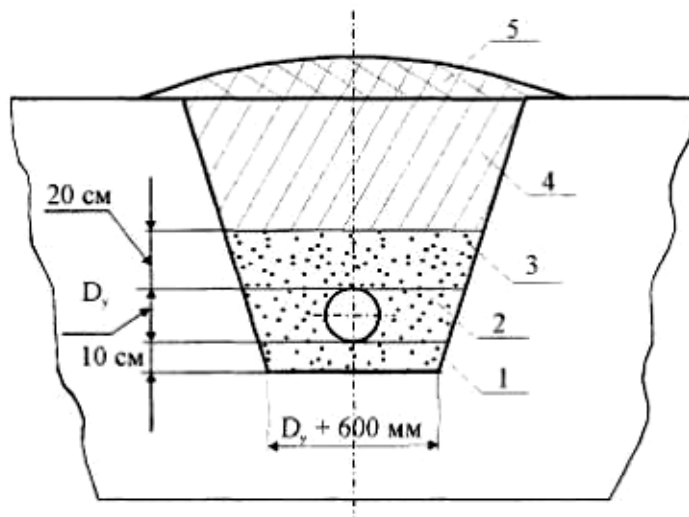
Схема укладки стеклопластиковой трубы в грунт:
